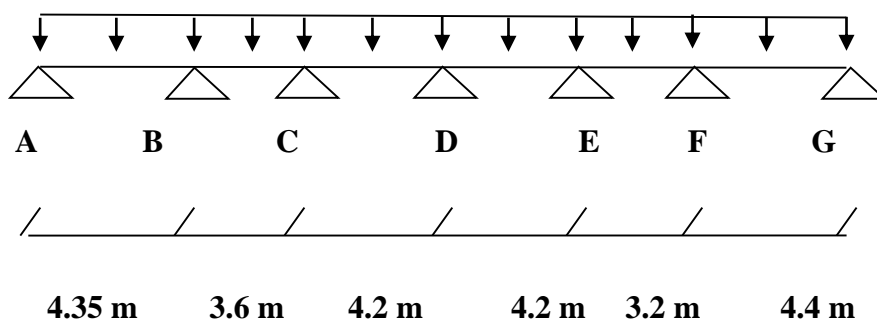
schéma statique de la poutre reposant sur sept appuis.
